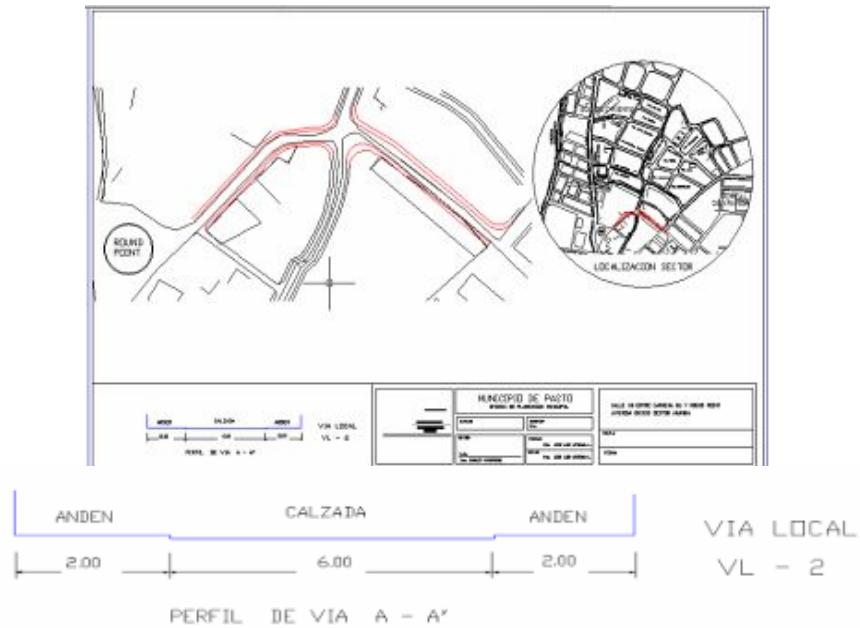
Planta y sección transversal calle 35 entre carrera 26 y round point de la Avenida Inesco
